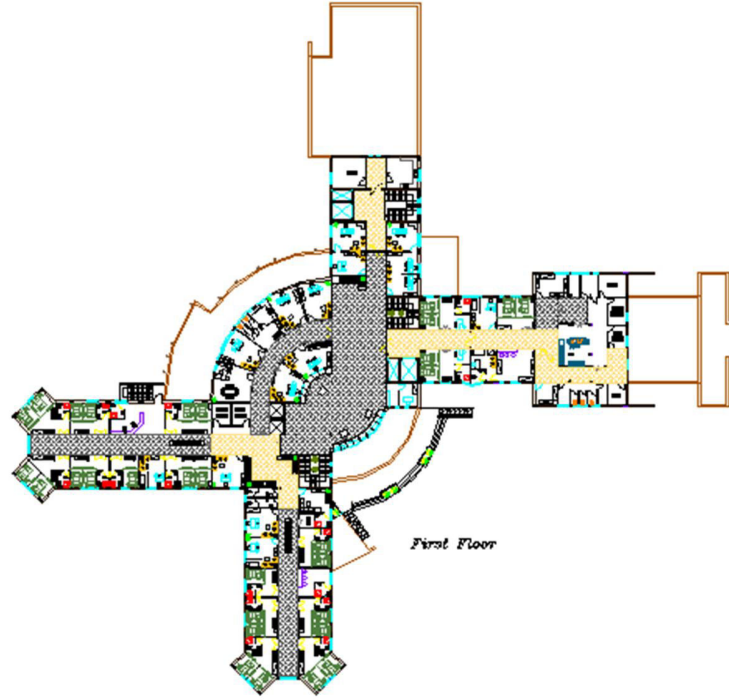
المسقط الأفقي للطابق الأرضي.
